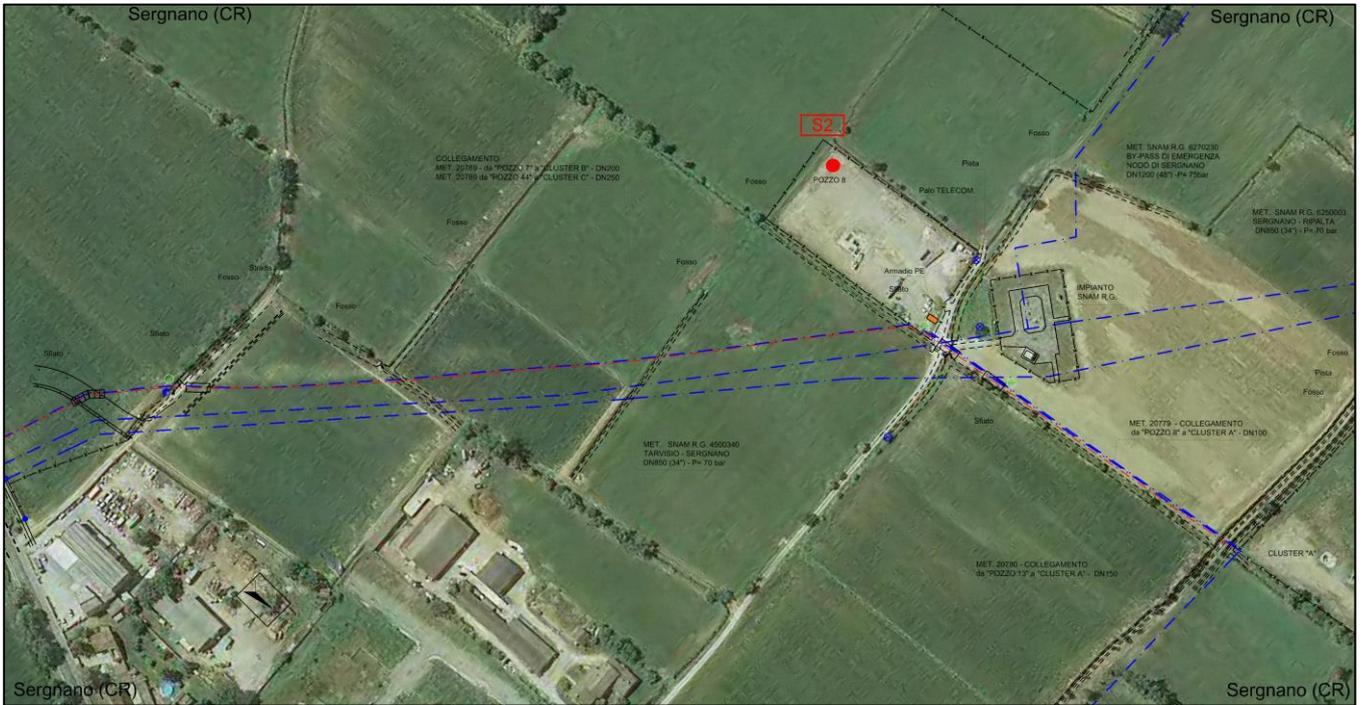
Planimetria di dettaglio ubicazione sondaggio S2
